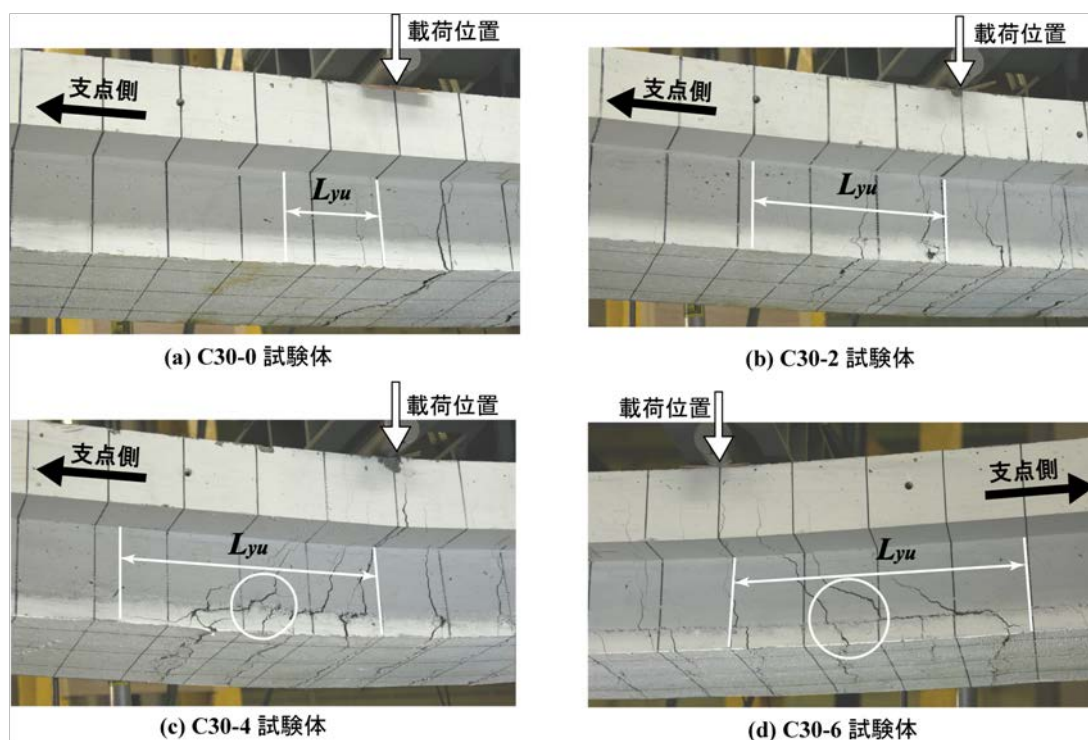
最大荷重時近傍のひび割れ性状
